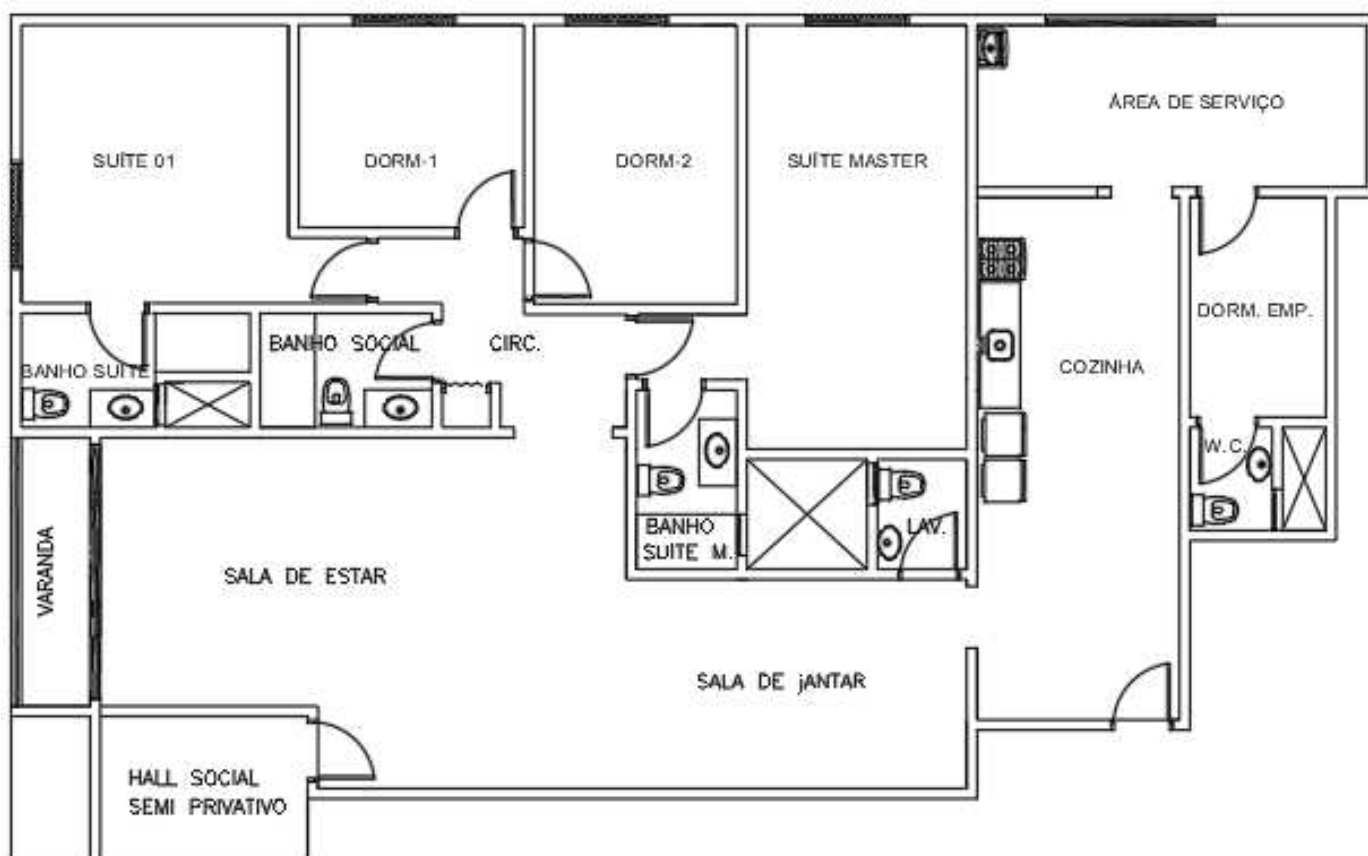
PLANTA BAIXA DO IMÓVEL IN LIDE SEM ESCALA
